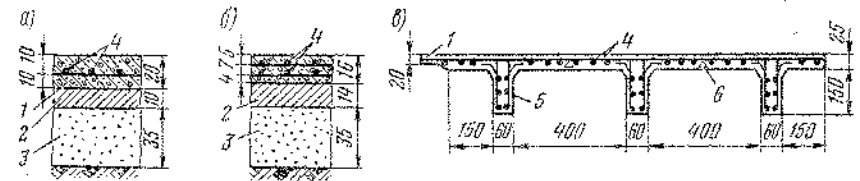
Конструкция непрерывно армированного покрытия:
